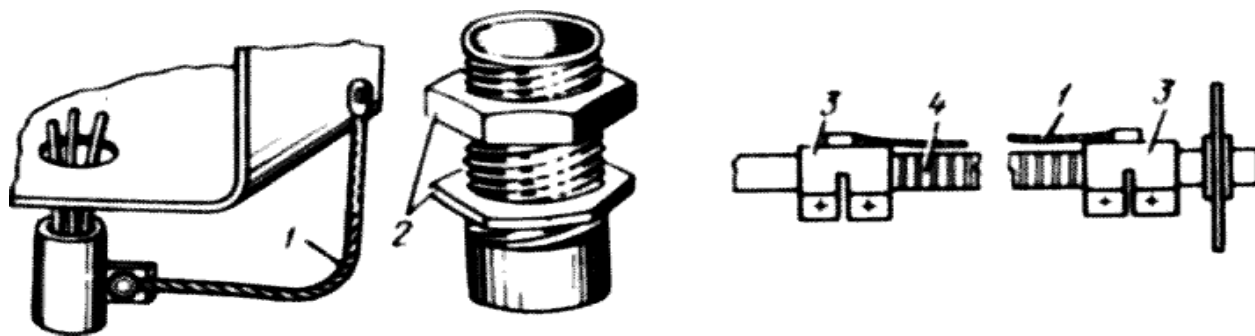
Зануление (заземление) труб: 1 - гибкая перемычка; 2 - заземляющие гайки; 3 - муфта типа ТР; 4 - металлорукав.
